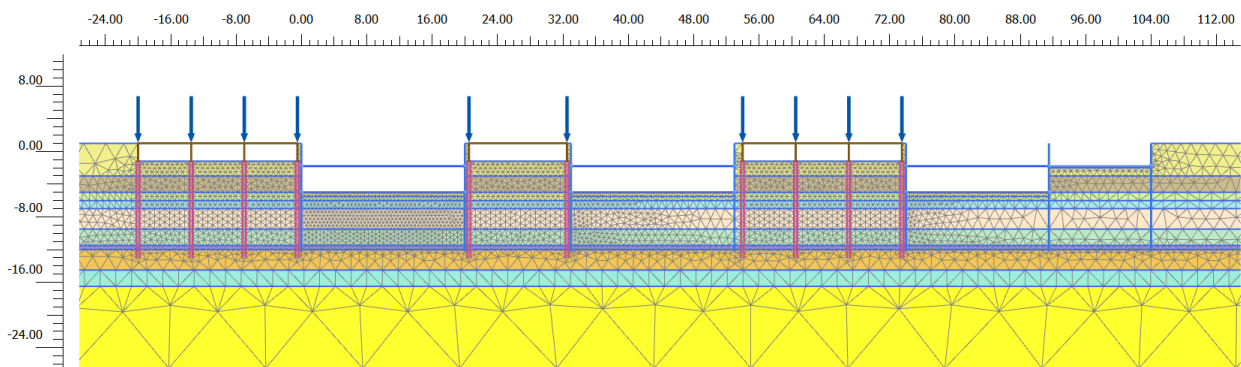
doorsnede 2 bestaande bebouwing met nieuwe kelder, met schematisering van de damwanden
